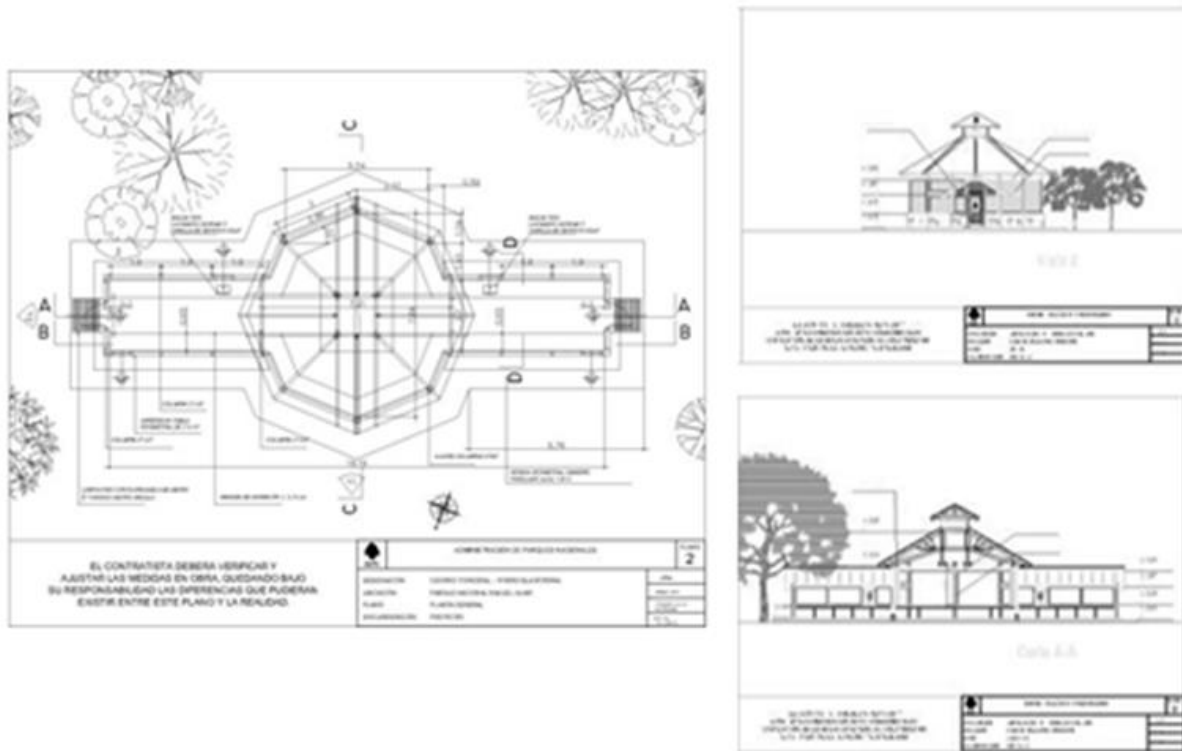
Planta y Cortes Centro Forestal. Fuente: CFIV PNNH. Obra de fundaciones y montaje
